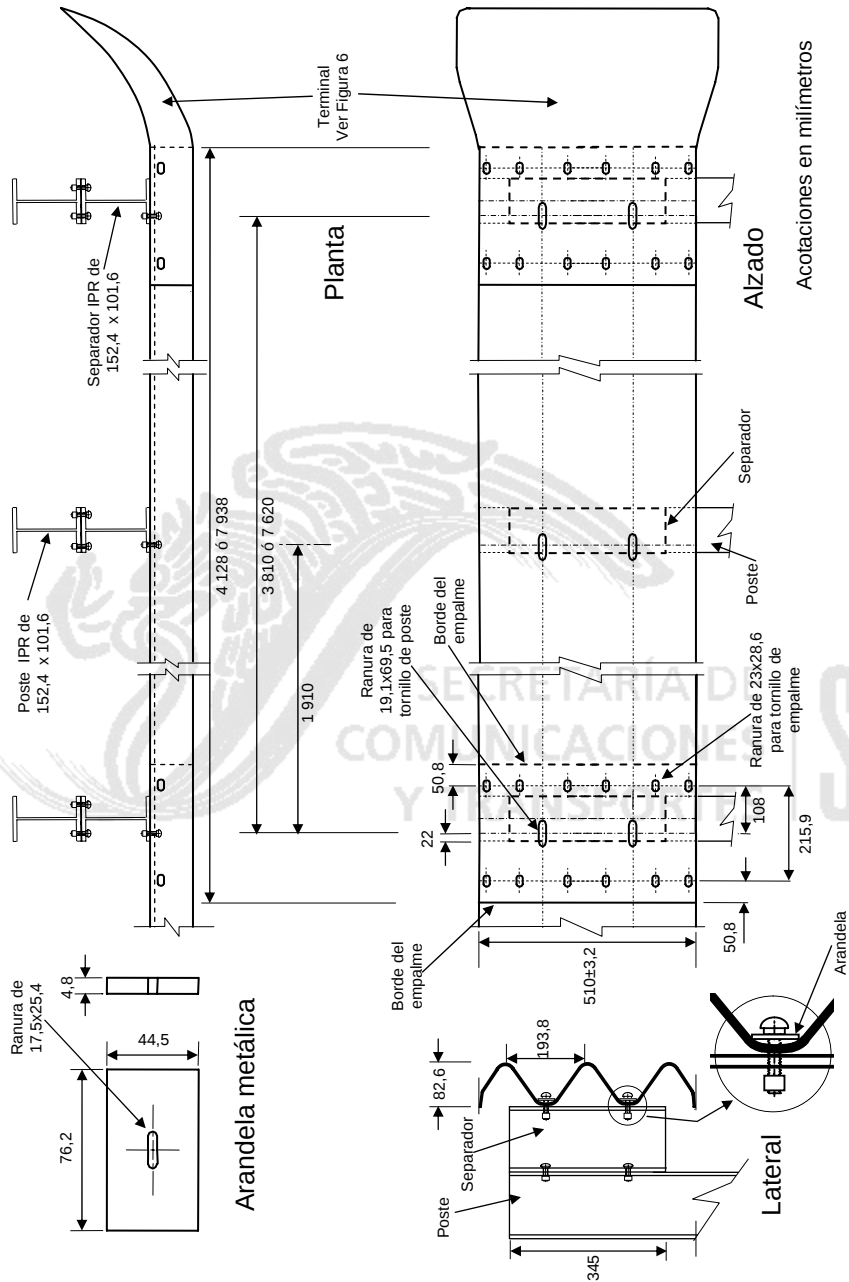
Sistema de defensa con vigas acanaladas de tres crestas
